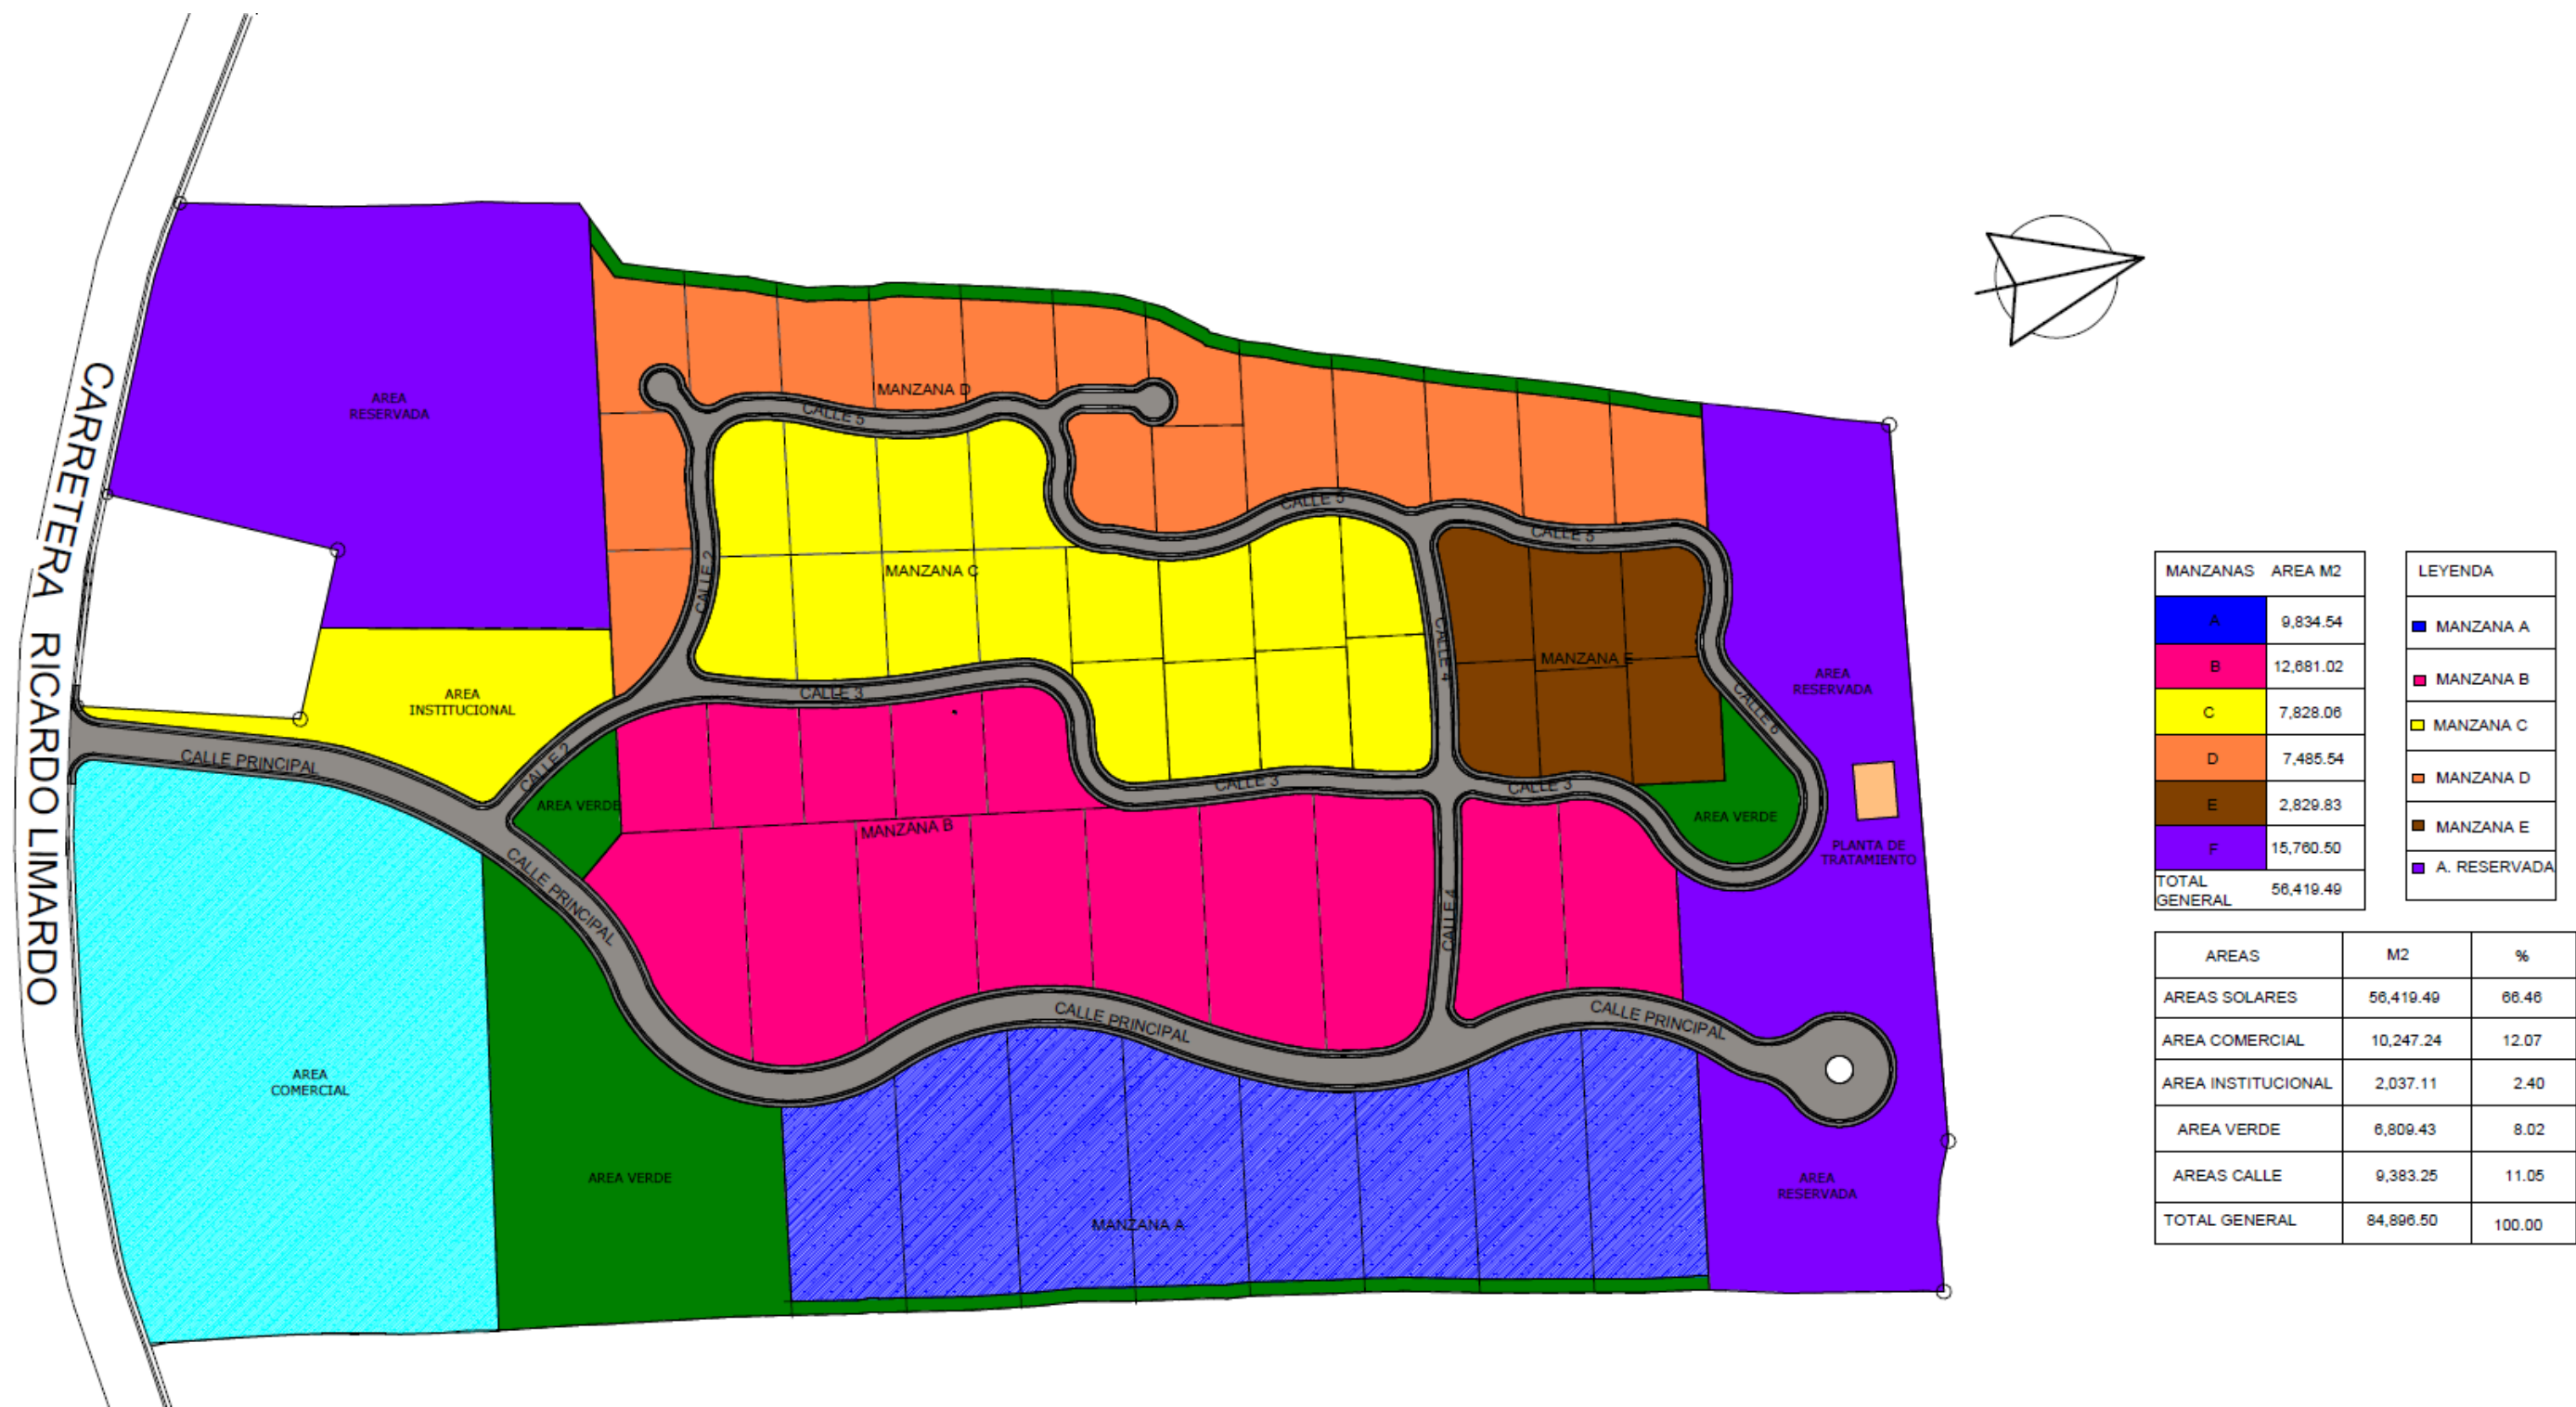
Plano de conjunto del proyecto, indicando zonas, áreas en m² y porcentaje de ocupación.
